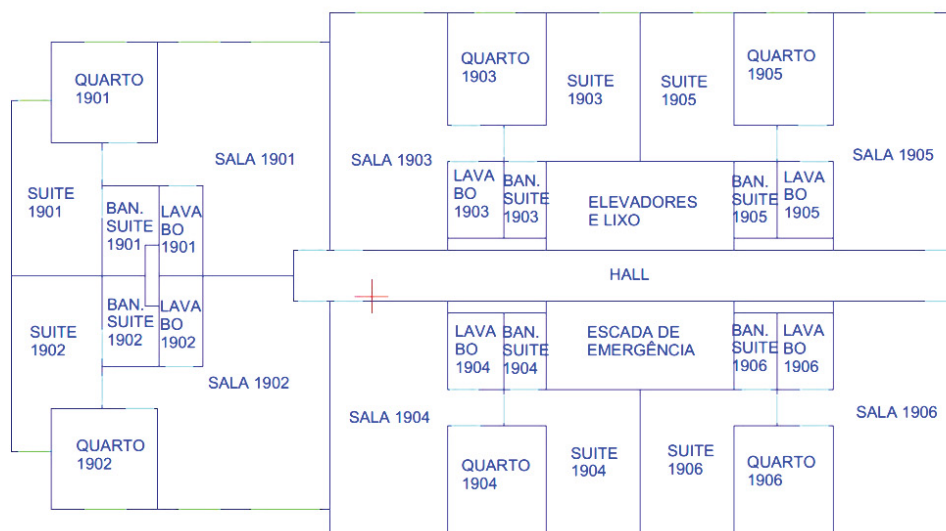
Planta Baixa do pavimento TIPO 2, pavimentos 14 a 19.
